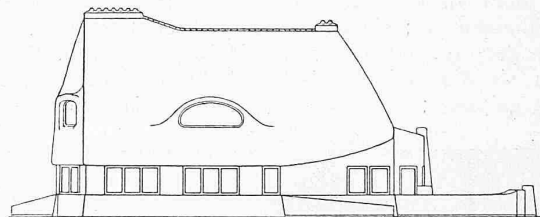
und 30. Grundrisse und Aufriss zu Abb. 23. — Etwa 1 : 300.
